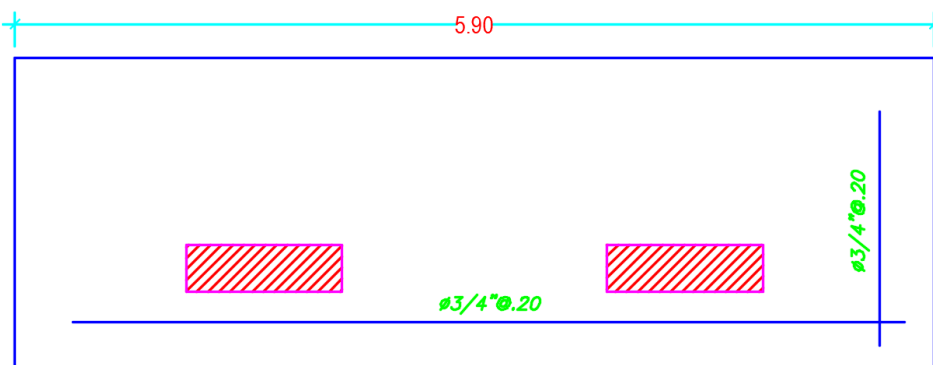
Detalle de refuerzo de acero en la zapata en planta.
